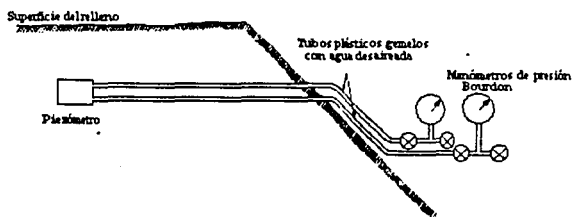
Ubicación del piezómetro cerrado tipo USBR en un terraplén.
